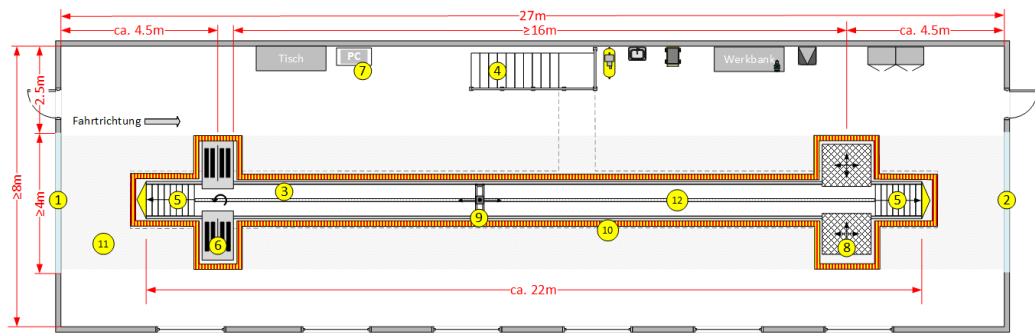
Grundriss Muster-Prüfhalle mit Minimalmassen
